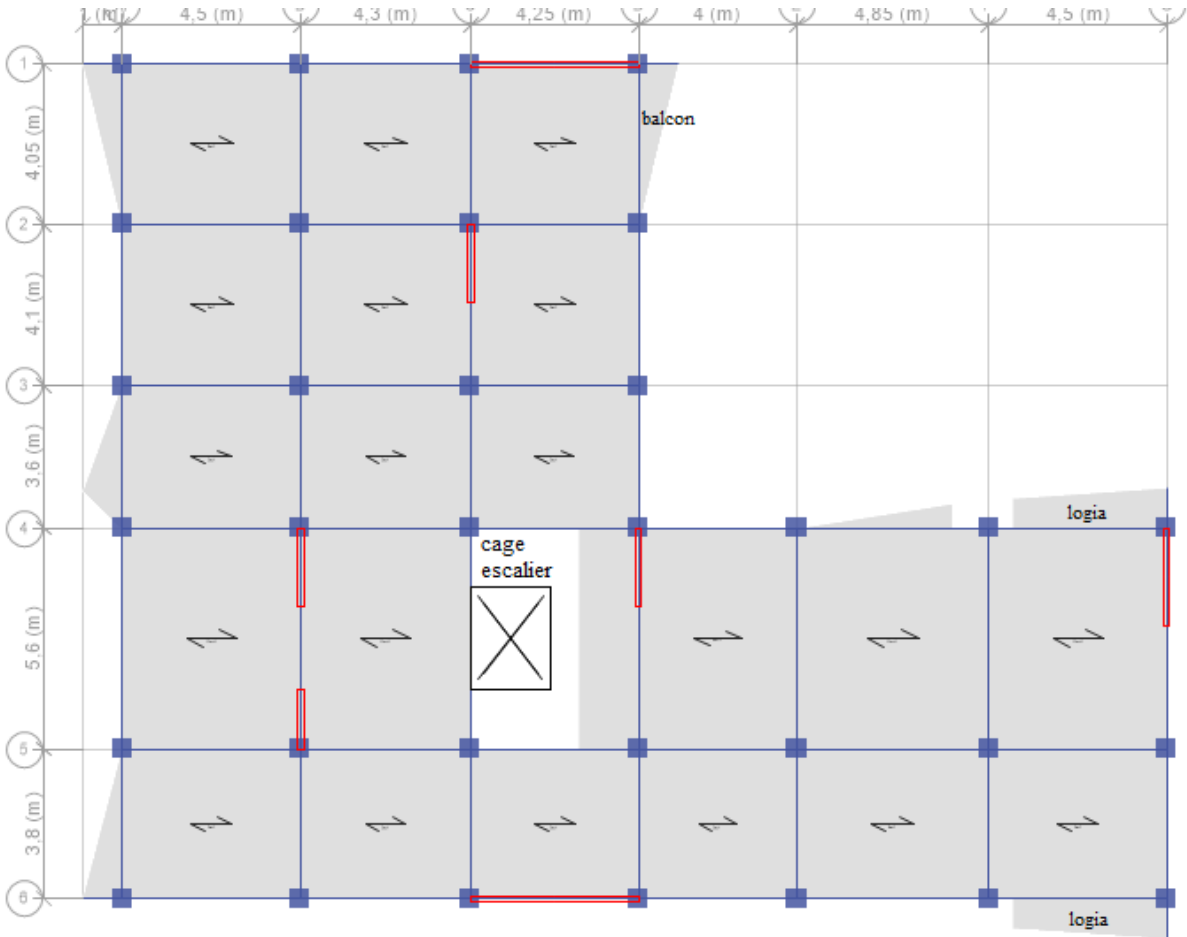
Schéma de la disposition des poutrelles pour étage (2 à 9).
